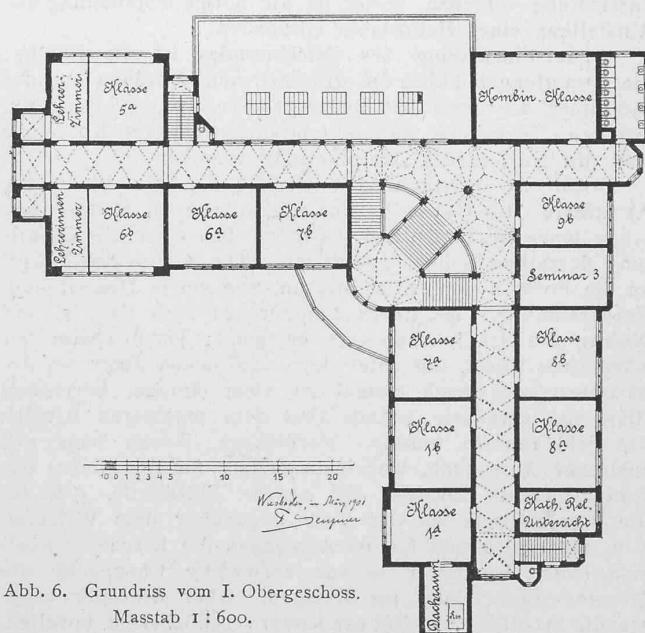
Grundriss vom I. Obergeschoss.
